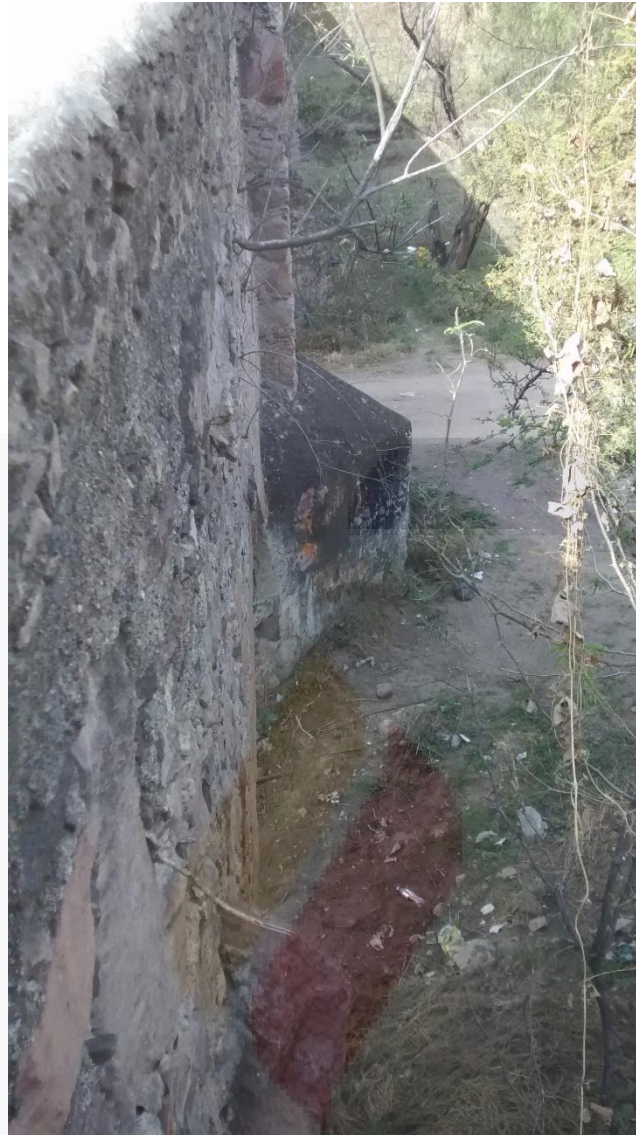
Pilar del puente de San Ignacio, aguas arriba. Fuente propia.
